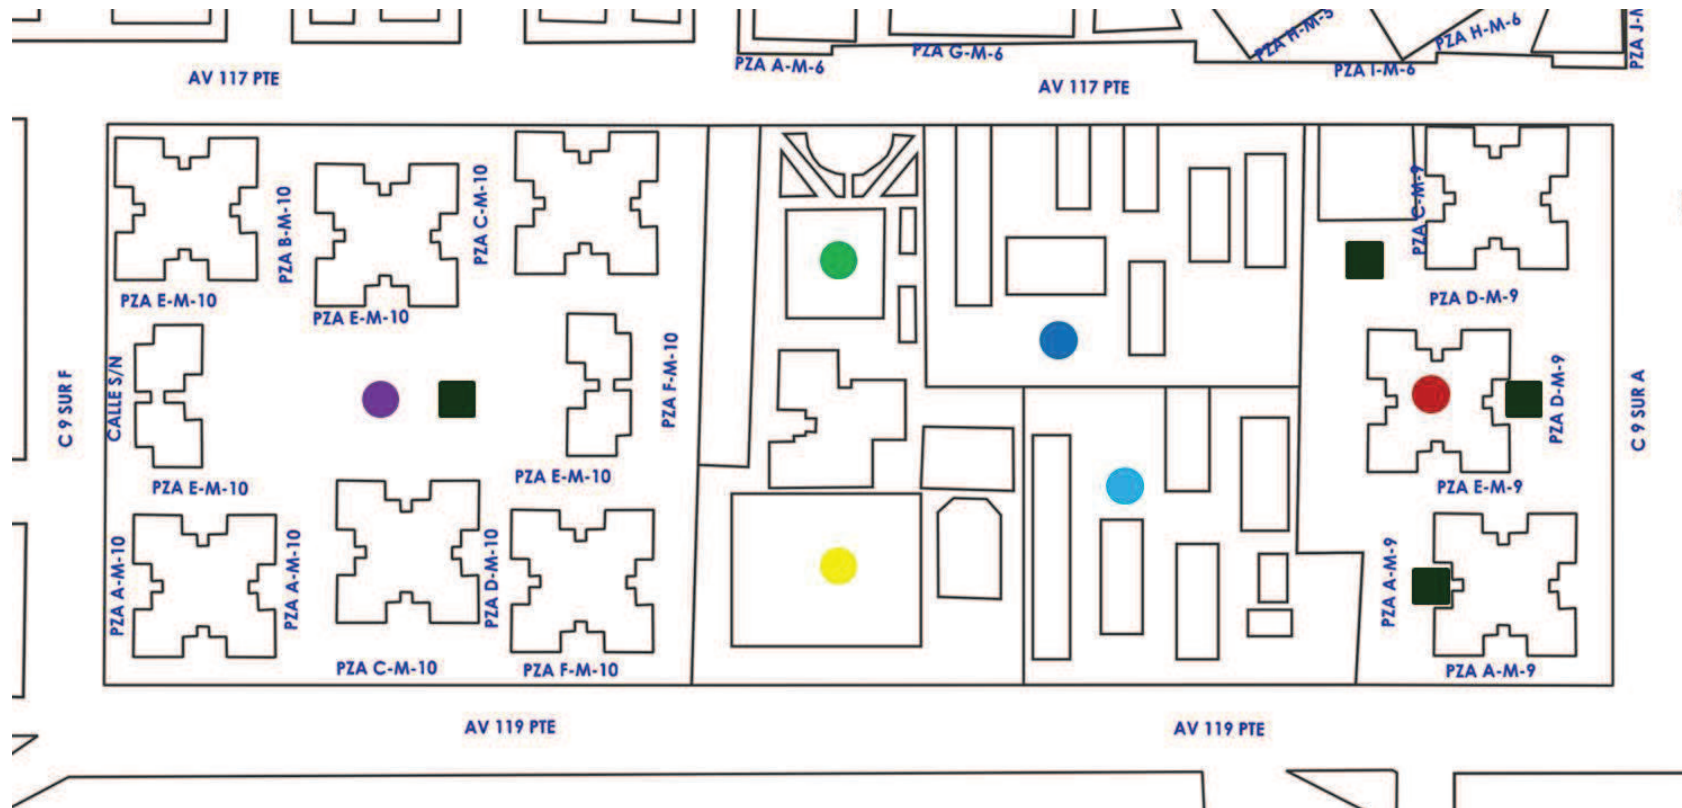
Plano de zonas a intervenir. Por: VRA, 2014
